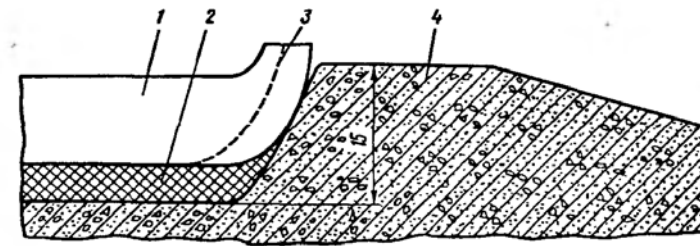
Срез резиновой напильной прокладки: 1 — подкладка; 2 — напильная прокладка; 3 — положение подкладки до среза прокладки; 4 — шпала
